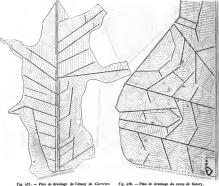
Plan de drainage de l'étang de Chevrier.
